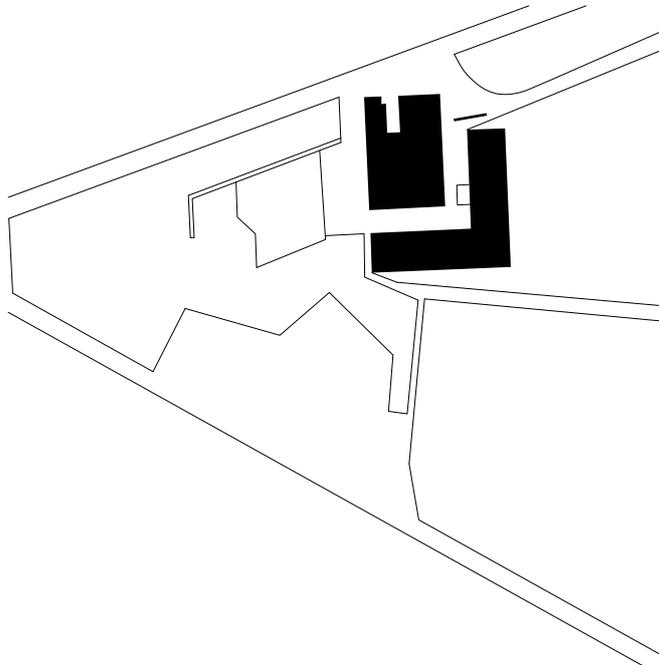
Lageplan St. Petri 1:2000 (BM)
